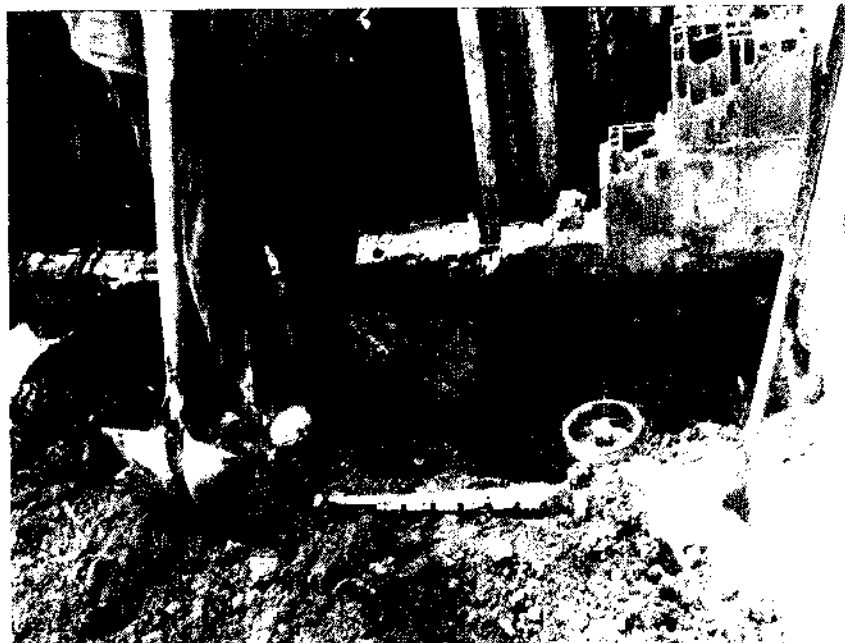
Vista da execução da ligação domiciliar
